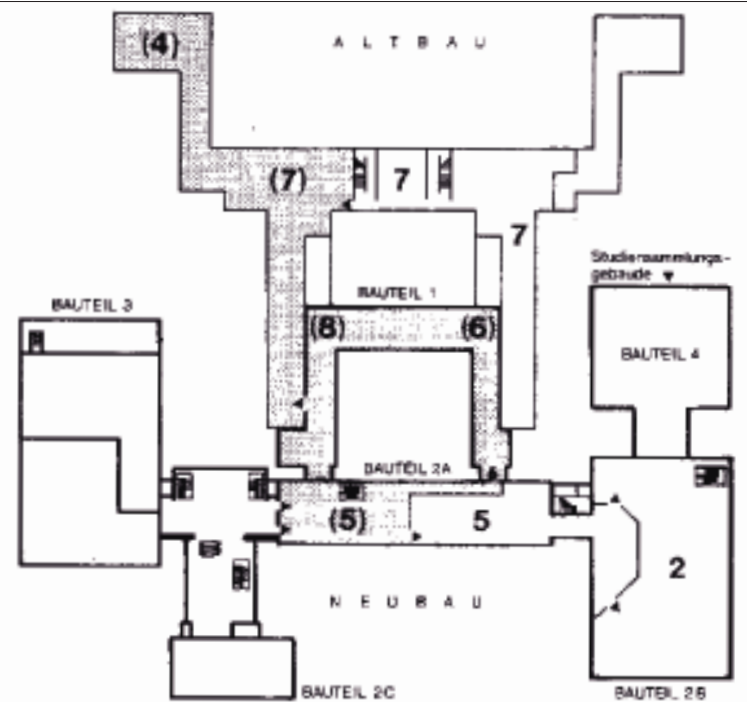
Grundriß der Museumsbauten in Dahlem. Ausstellungen im Obergeschoß von Altbau und Neubauten:
